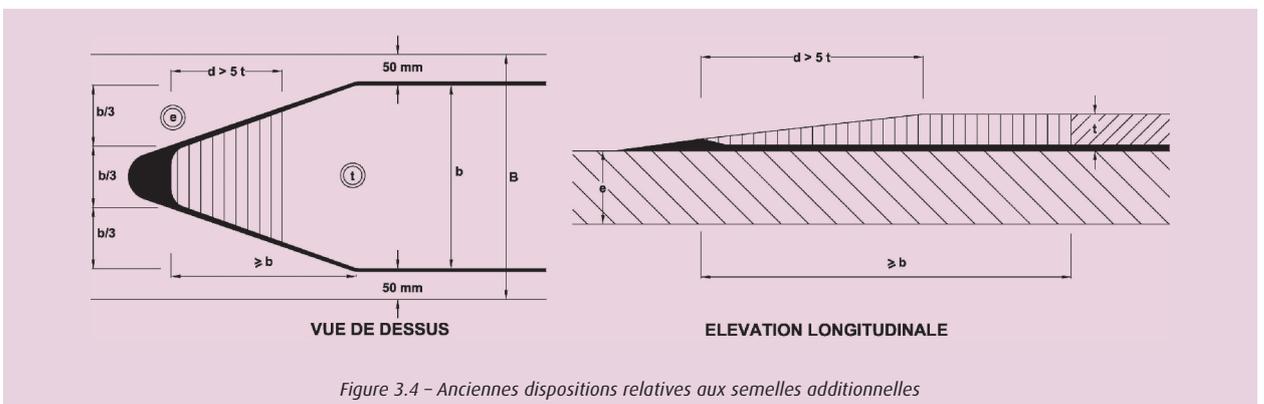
Anciennes dispositions relatives aux semelles additionnelles
